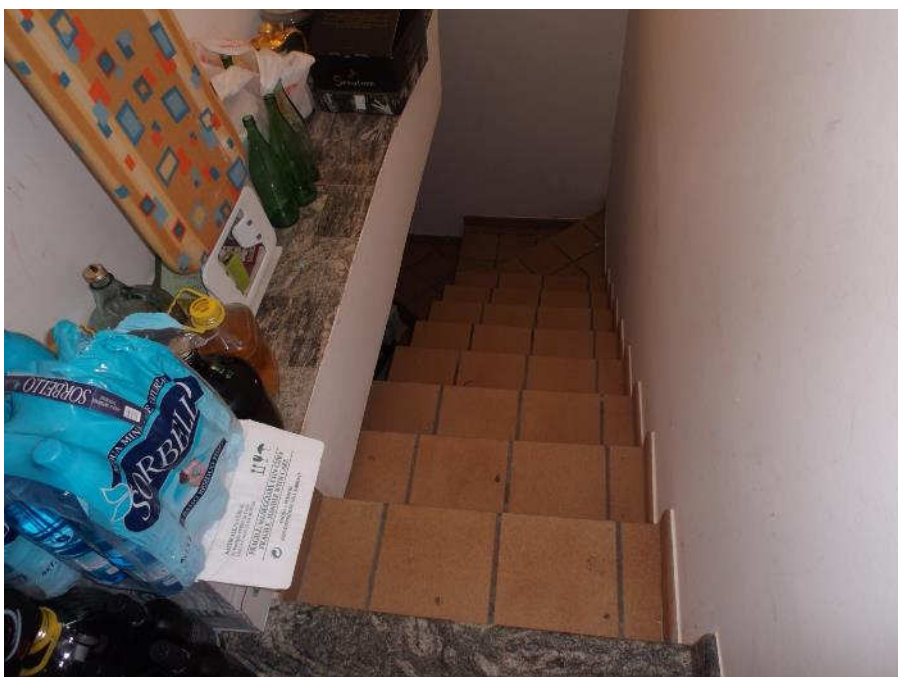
Scala di collegamento piano interrato-piano terra lato est (sub 7)
